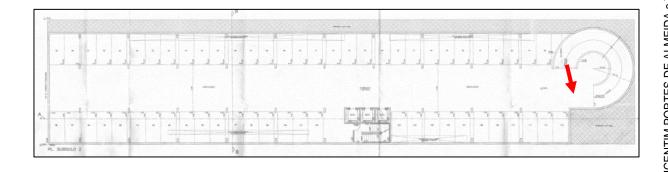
Acesso ao terceiro subsolo.
